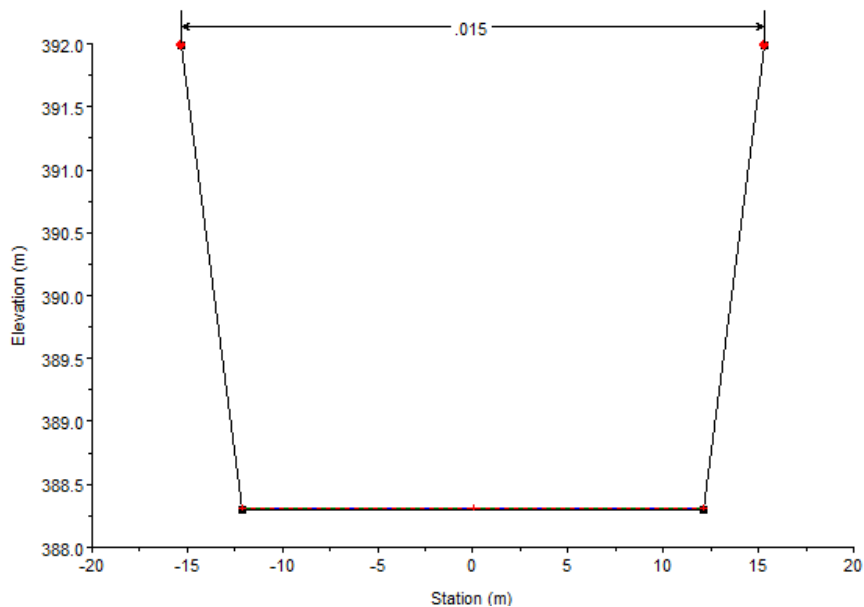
Sección tipo 2, tramo 1.2 del canal de Monegros.
